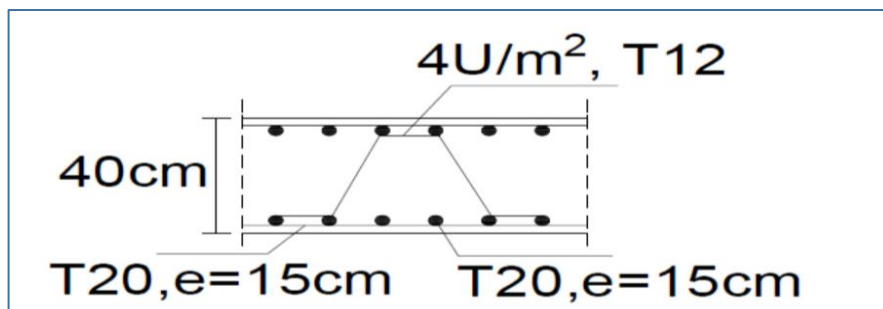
Ferrailage de la dalle du radier sur travée.
